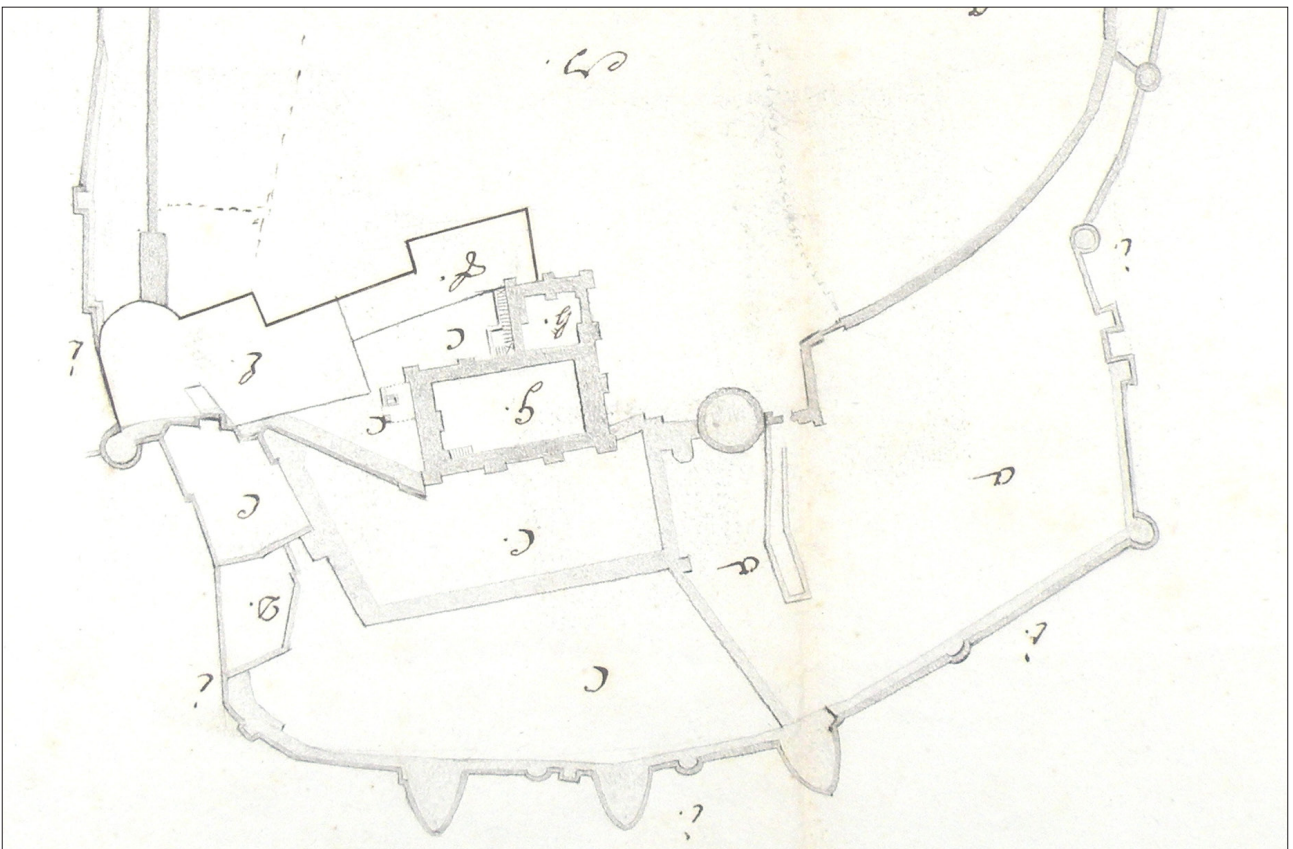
Détail du « plan de la portion du château de Loches où est établi la maison de correction du département d'Indre et Loire » par Lemaistrec, 1810 (ADIL IV/31.2.1)
